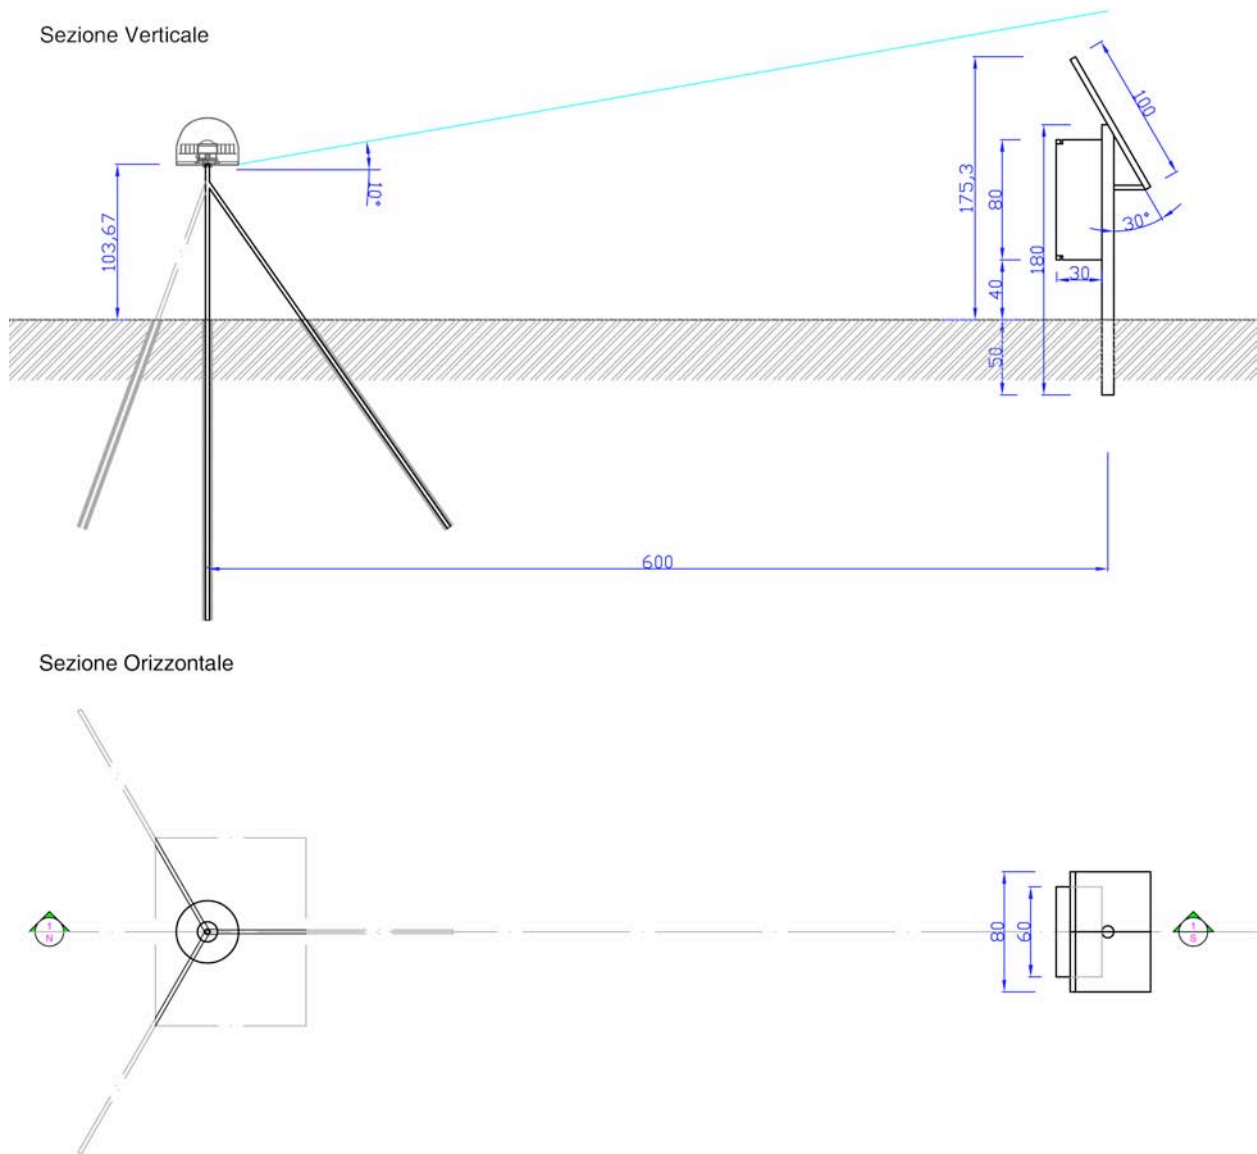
Schema costruttivo, pianta e sezione, di una stazione geodetica completa.
